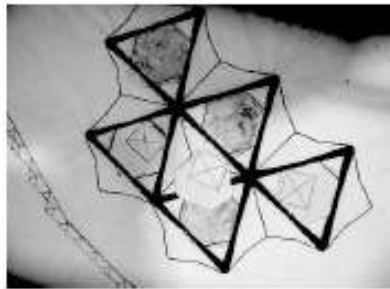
Detalle soporte tetra octaédrico de la City Hall Tower 1952. Fuente, Kahn Collection, AAUP.
